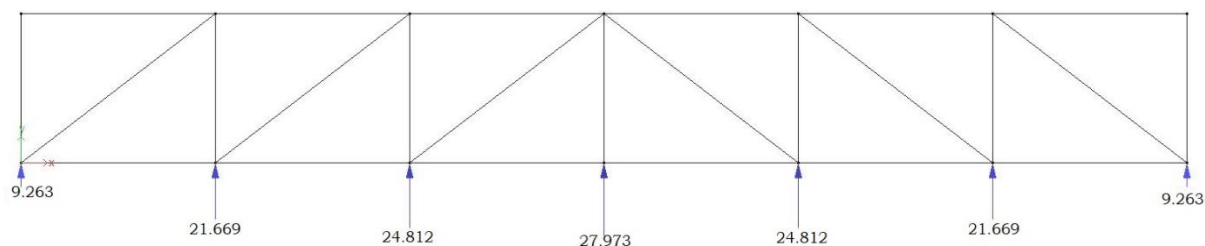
Esquema de carregamento dos contraventamentos de cobertura (Viga de Pratt)
